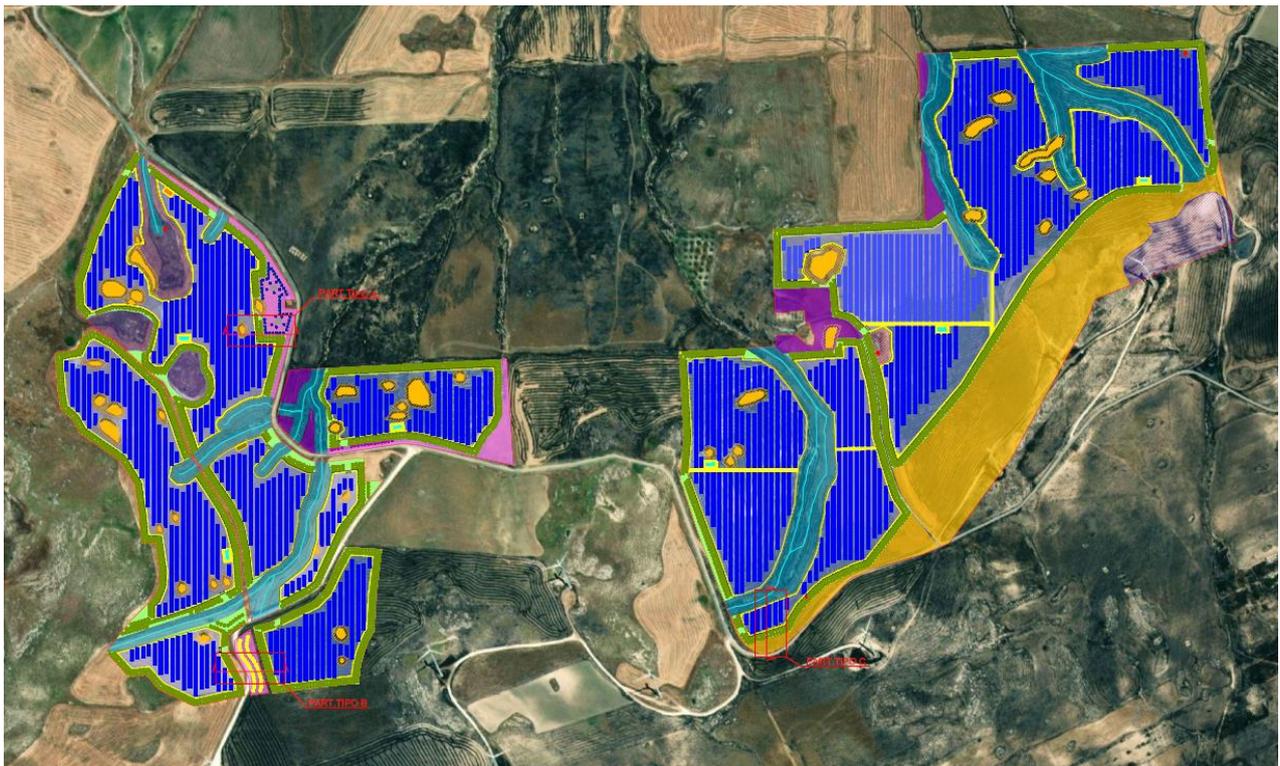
PLANIMETRIA SISTEMAZIONE A VERDE OPERE DI MITIGAZIONE (ESTRATTO DA MINEO-PDT11)
